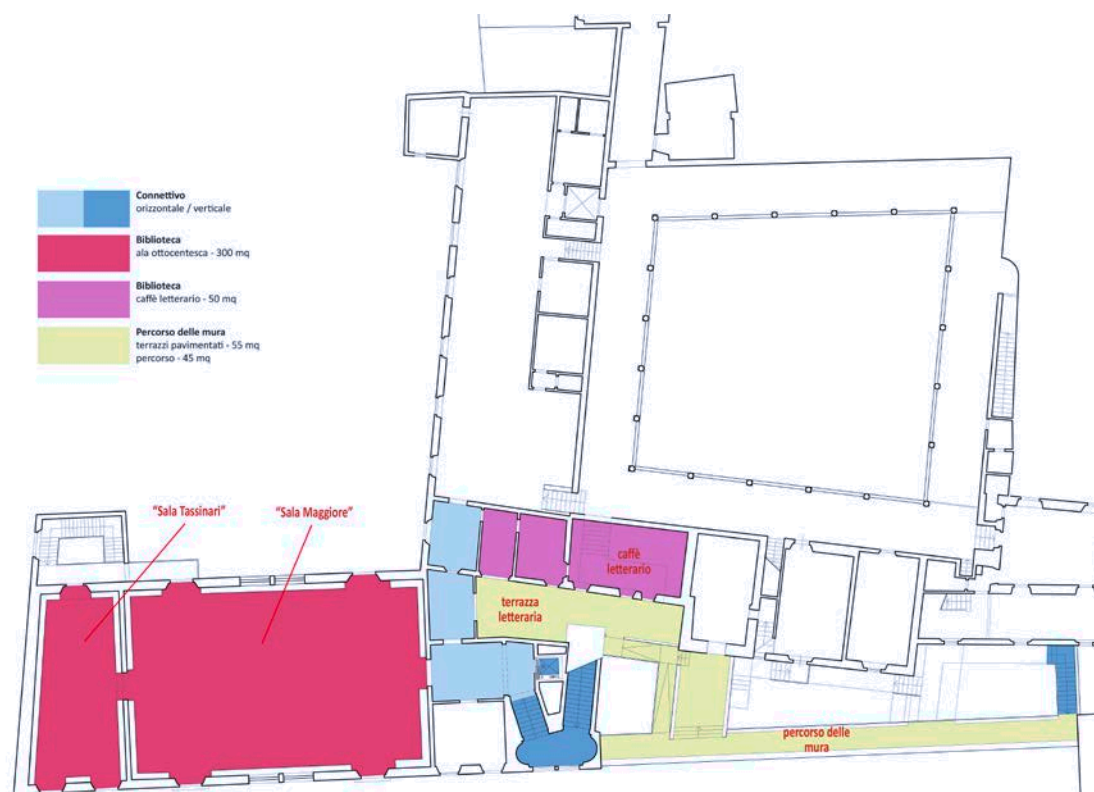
PIANTA PIANO PRIMO / STATO DI PROGETTO
